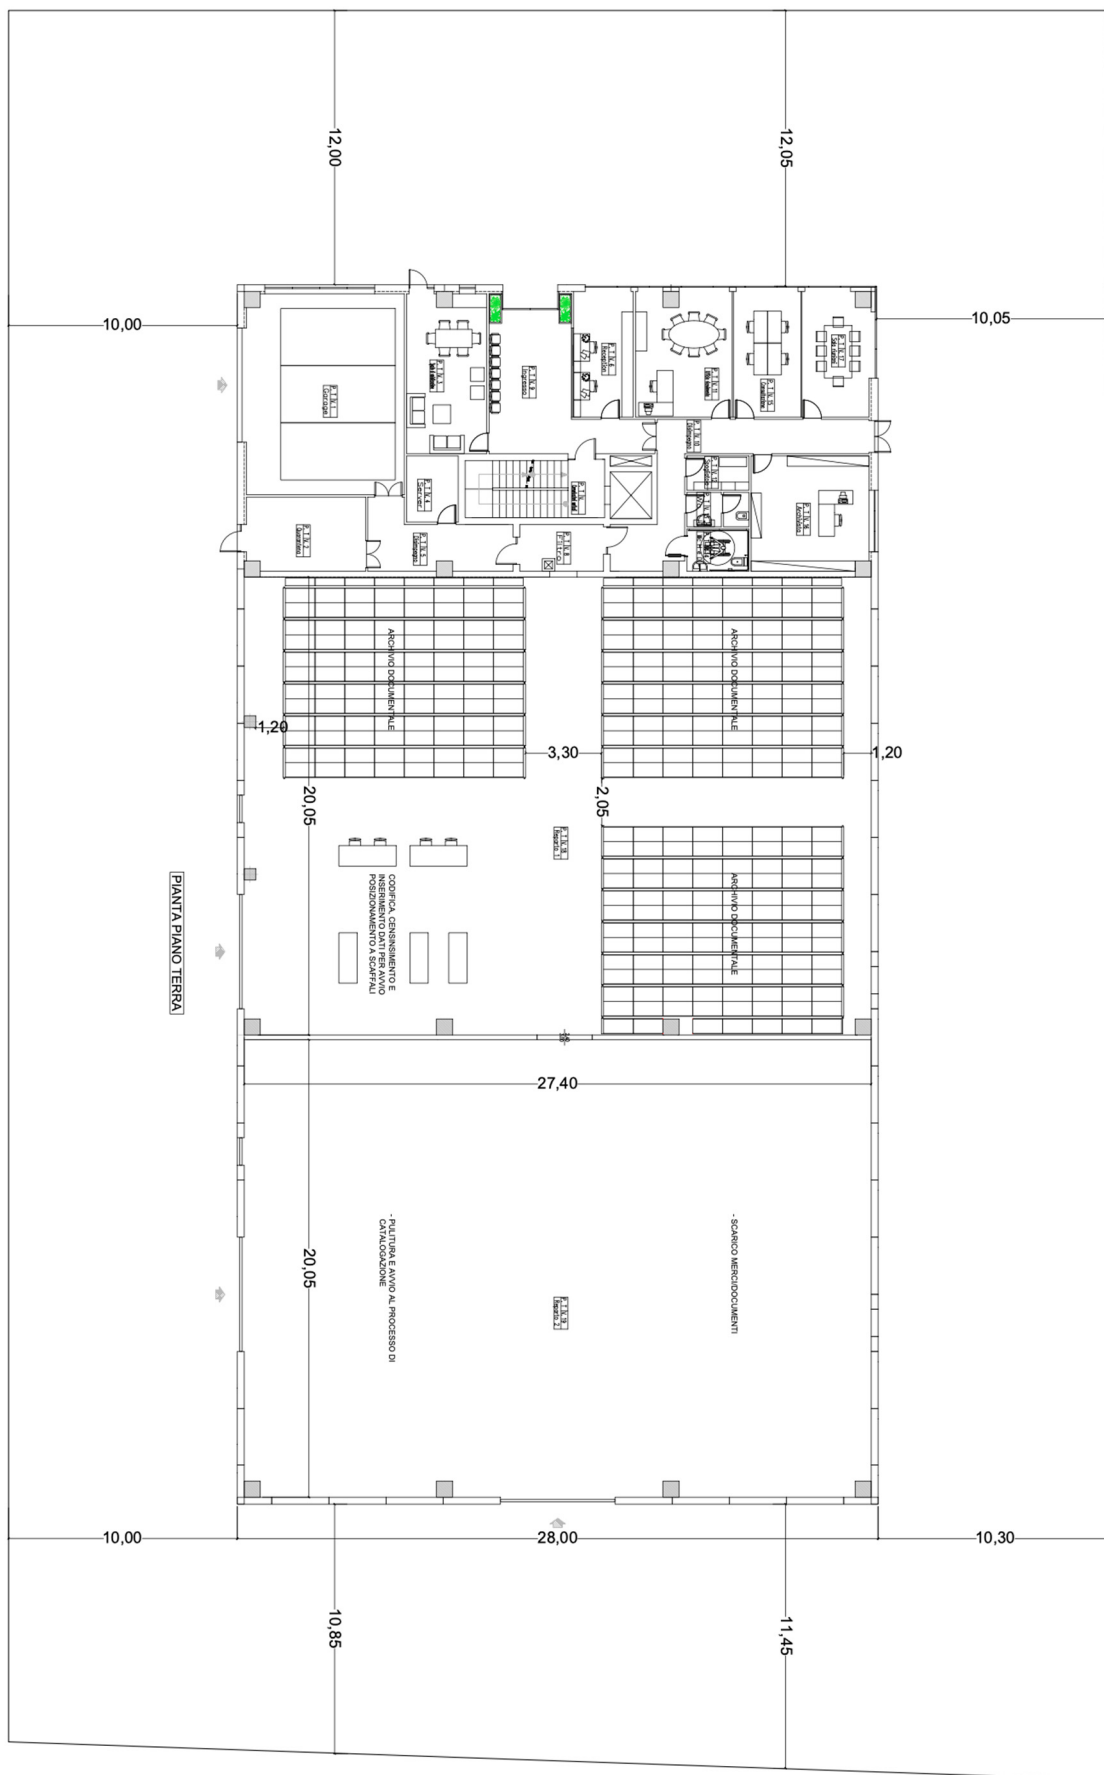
Planimetria esterna con riferimenti alla distanza della struttura rispetto al confine della proprietà.
